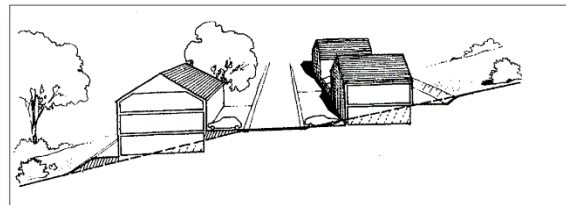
Blick auf die bereits bestehende Bebauung im Plangebiet (links) sowie eine mögliche Anordnung der neu zu errichtenden Bebauung (rechts). Mit einer Begrenzung der Höhenentwicklung und der entsprechenden Hangintegration sowie der Pflanzung volumenstarken Grüns kann eine optische Eingliederung des Plangebietes in das Landschaftsbild erfolgen. Quellen: CO3 2018 (links) | Guide d'urbanisme pour la Wallonie S. 150 (rechts)
